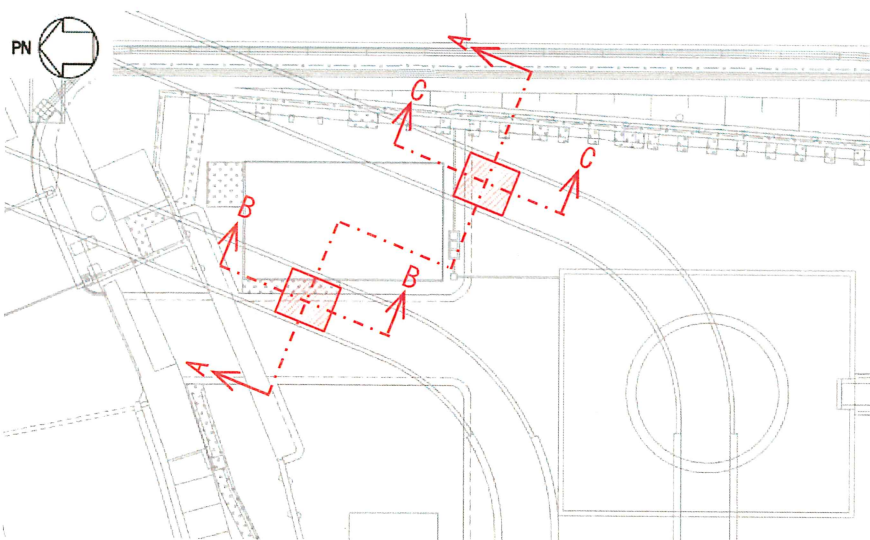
取放水路流路縮小工（第1号機取水路）(No.1)，(No.2)の平面配置図
